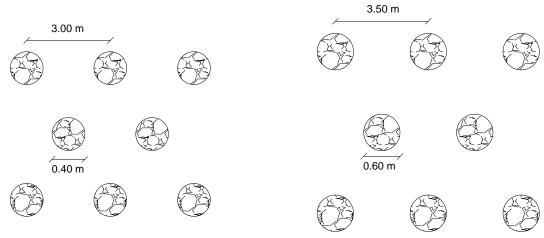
Distribución en Planta de los Pilotes o Columnas de Grava
